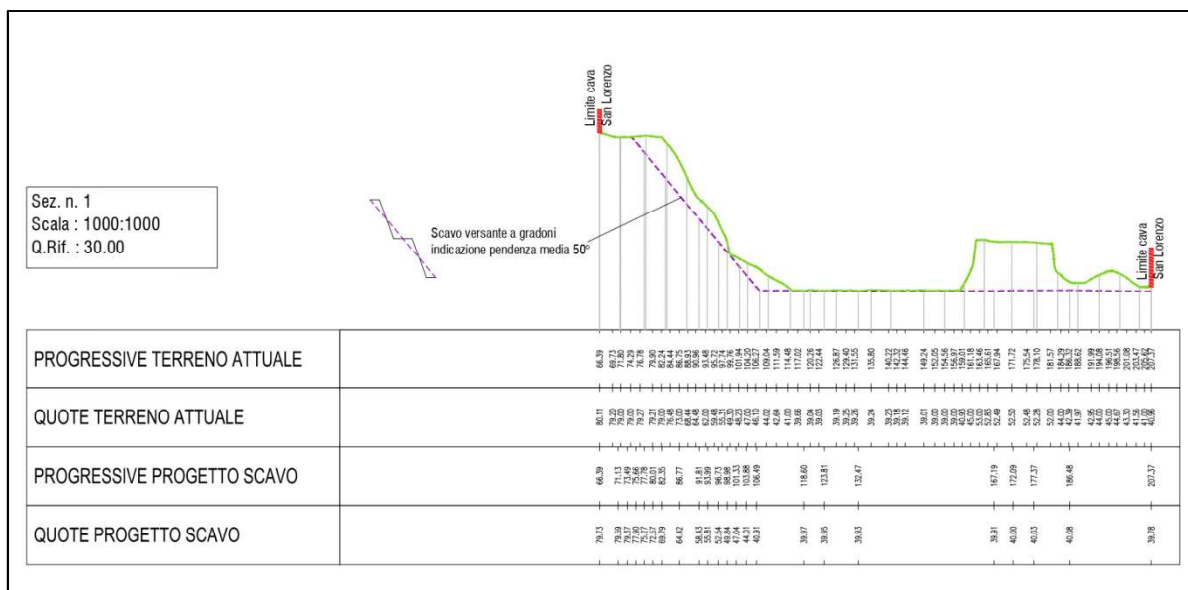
Estratto Elab.03-Sezioni dello stato attuale e progetto scavo autorizzato
